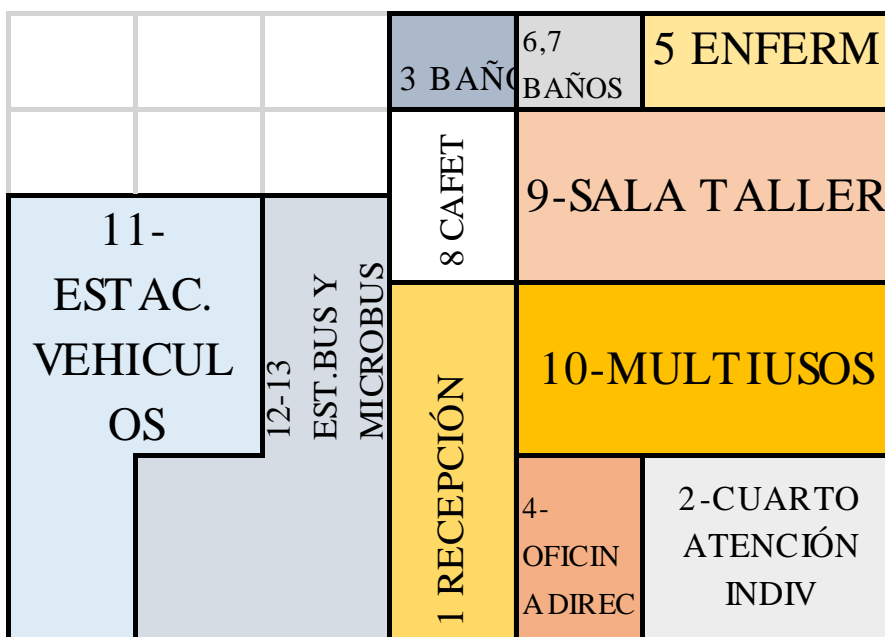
Elaboración de borrador a escala de la distribución en planta.
